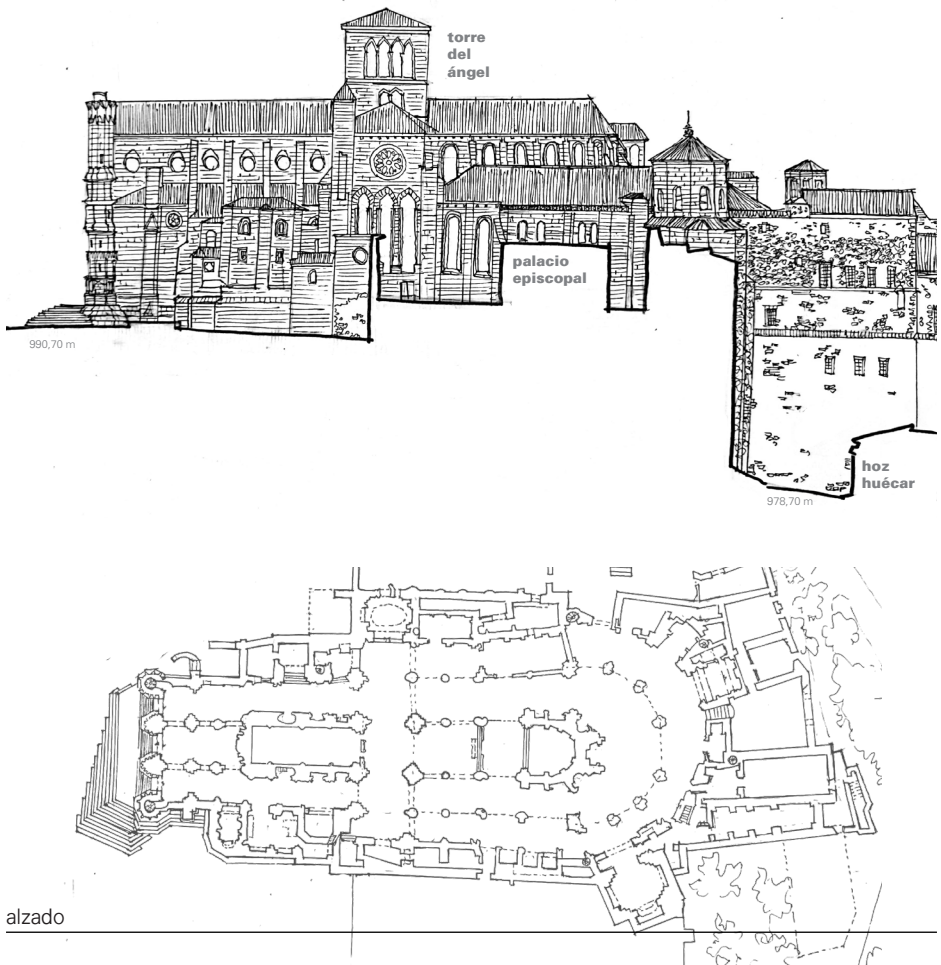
Alzado sur actual sobre plano de Gema Palomo. Elaboración propia
